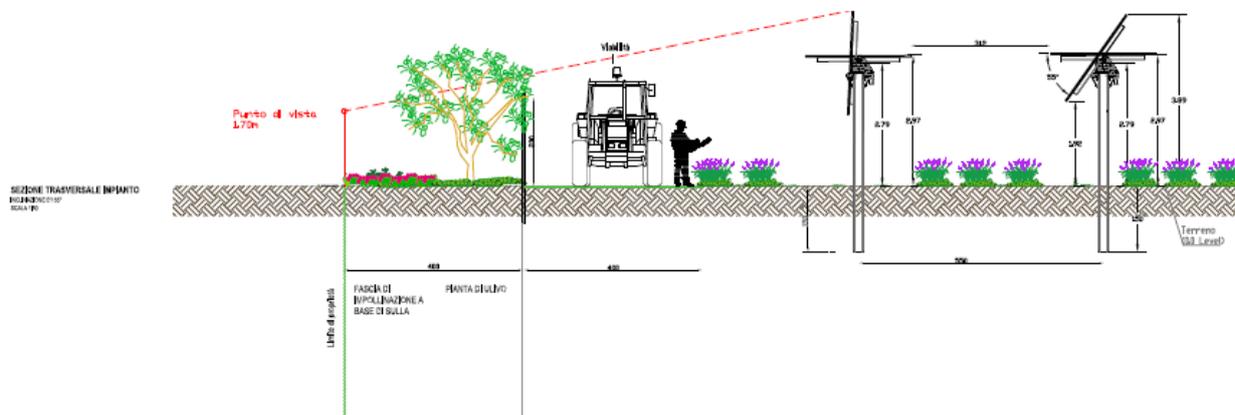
Sezione tipica della soluzione adottata con tracker alto (altezza in corrispondenza dell'asse di rotazione pari a 279 cm) ed interasse di 5,5 m
